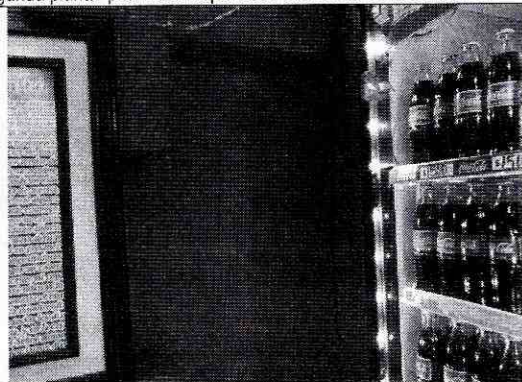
Estado actual de los muros interiores en el primer piso de la edificación. Se observan agrietamientos y fisuras de tendencia horizontal y vertical.
